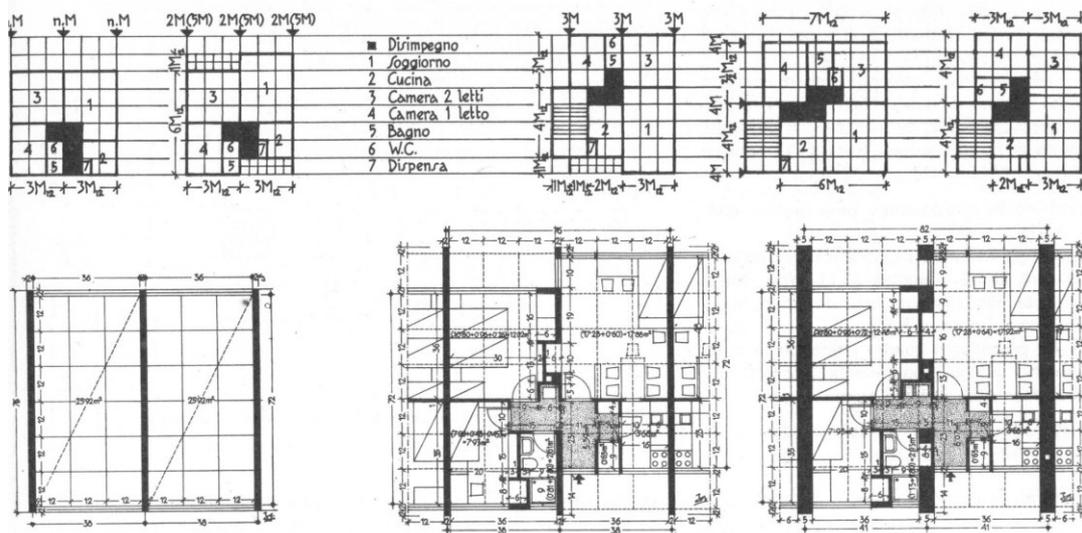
| Pianta modulari della seconda fase del Progetto AEP 174
